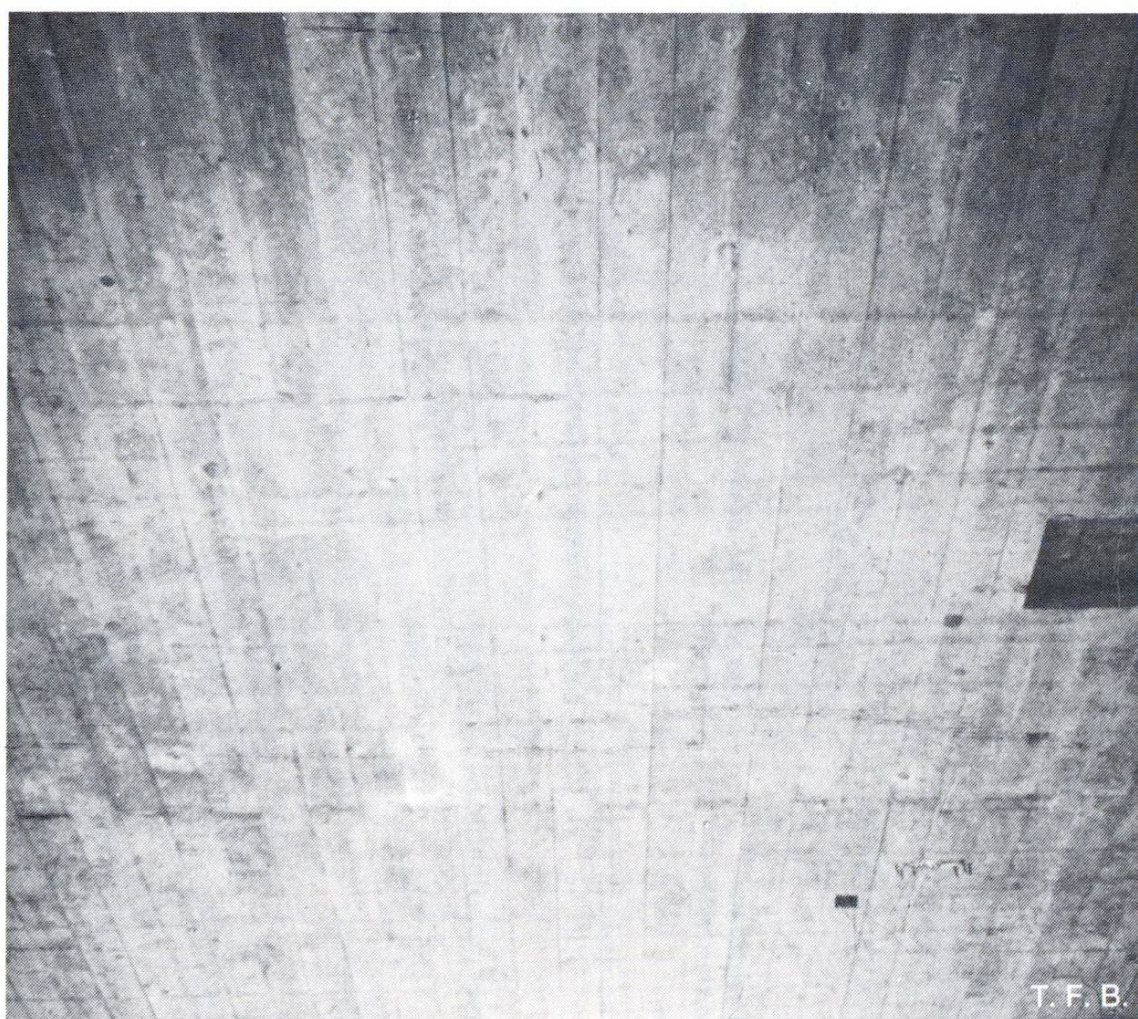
Traces de rouilles en stries à la face inférieure d'une dalle. Des barres fortement rouillées ont été laissées sur le coffrage où elles ont déposé de la poussière rouge.
